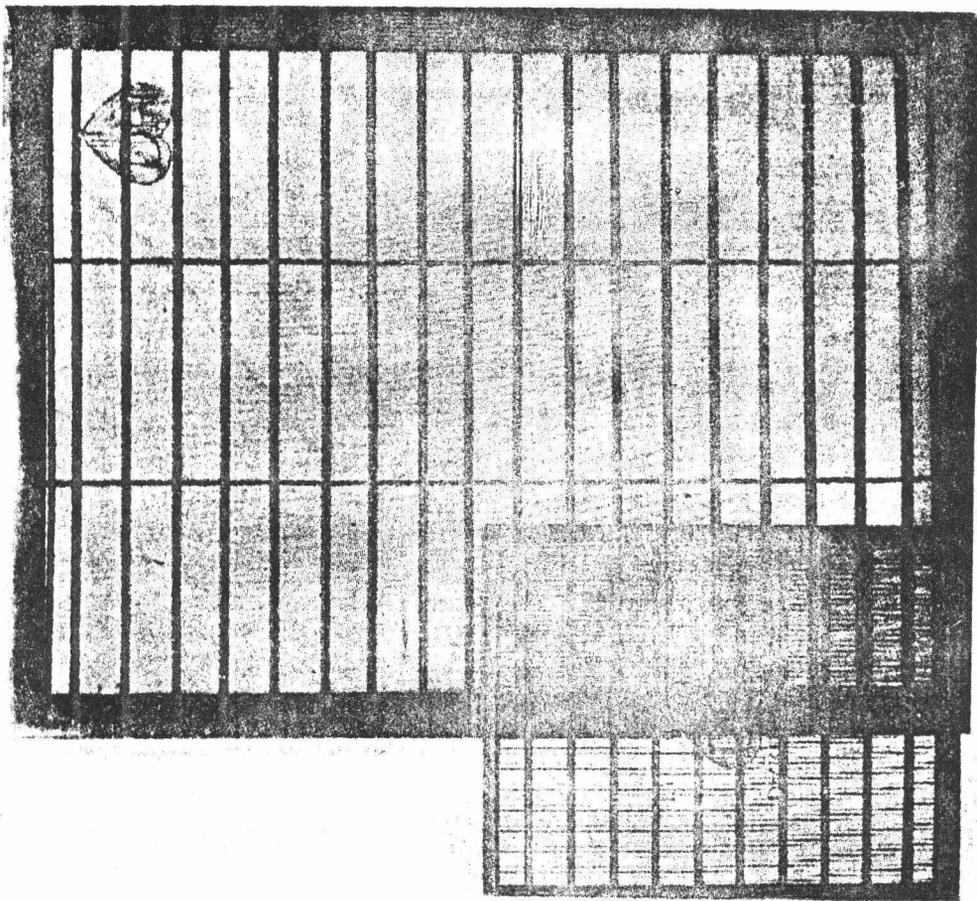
FIG. IV VISTA DE LA SUPERFICIE DEL MOLDE Y
